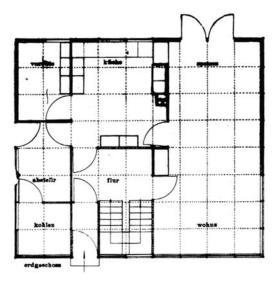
Planta baja de la vivienda nº 17 en Weisenhof Siedlungen. Coordinación modular (Nerdinger 1988)
